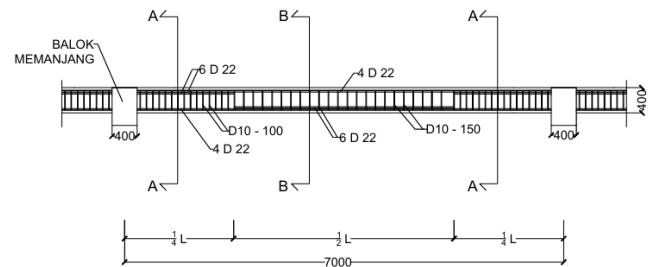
Detail Penulangan Balok Induk Memanjang
